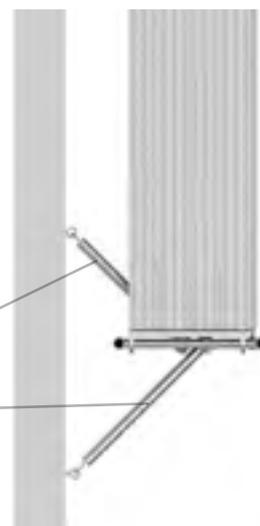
V- Gerüsthalter in Verwendung mit Innenkonsolen
